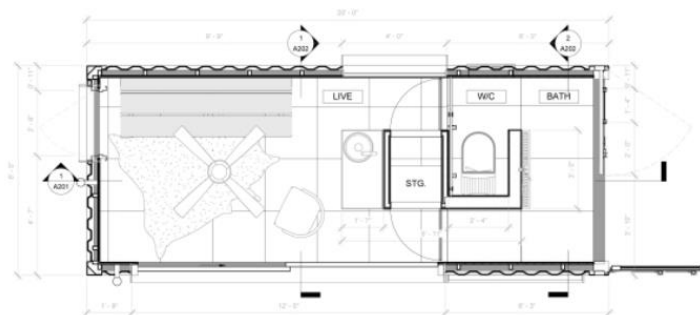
Vista en planta del Modelo NOS1. (New Old Stock, 2016).
